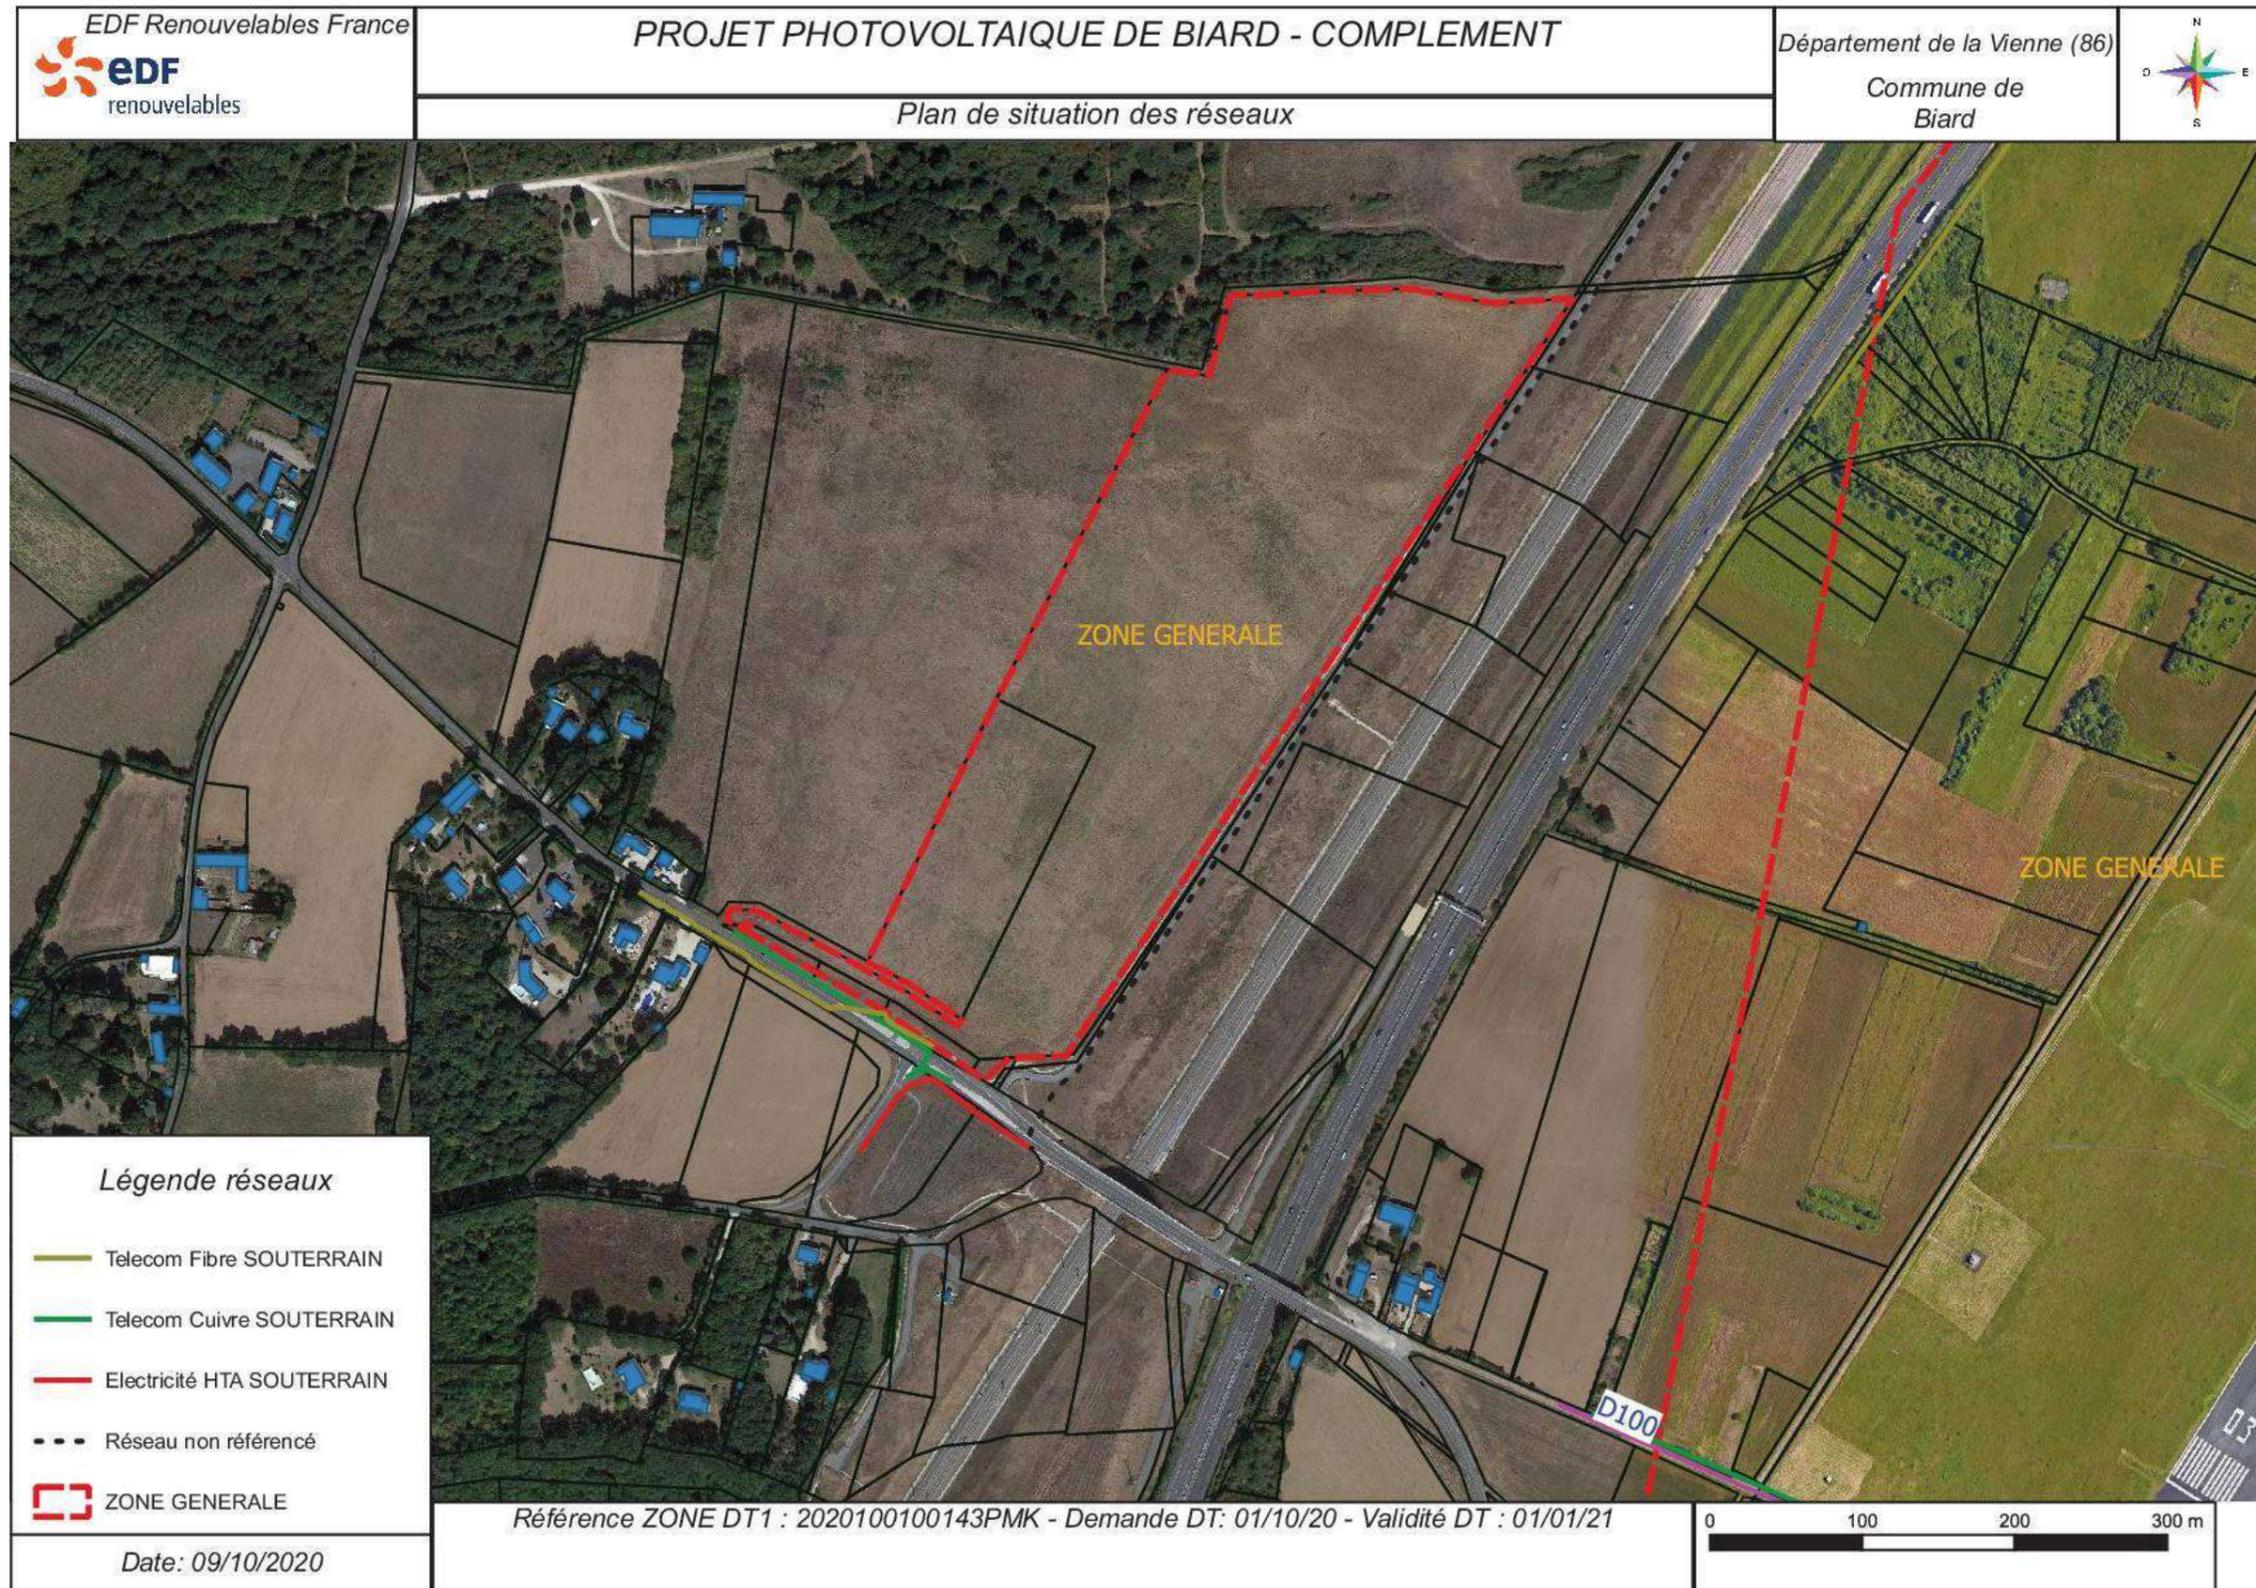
Plan des réseaux (source : EDF Renouvelables France)
